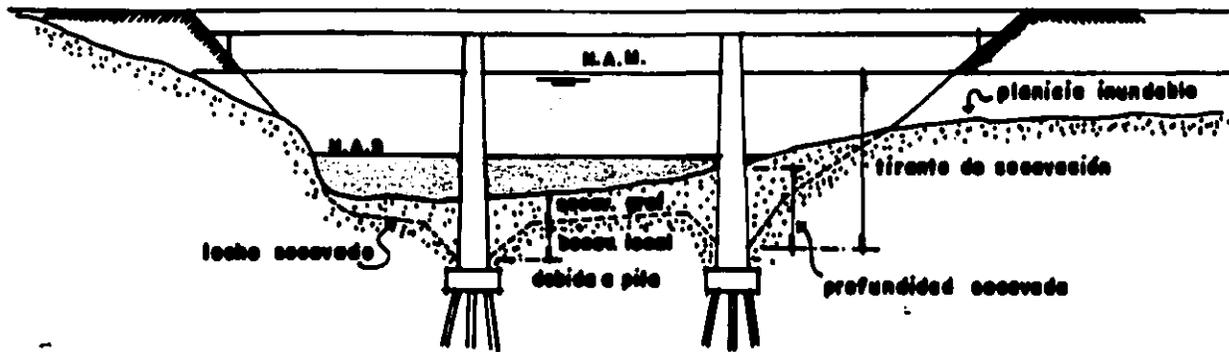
Sección transversal en el estrechamiento de un puente donde se ilustra la terminología para excavación.
